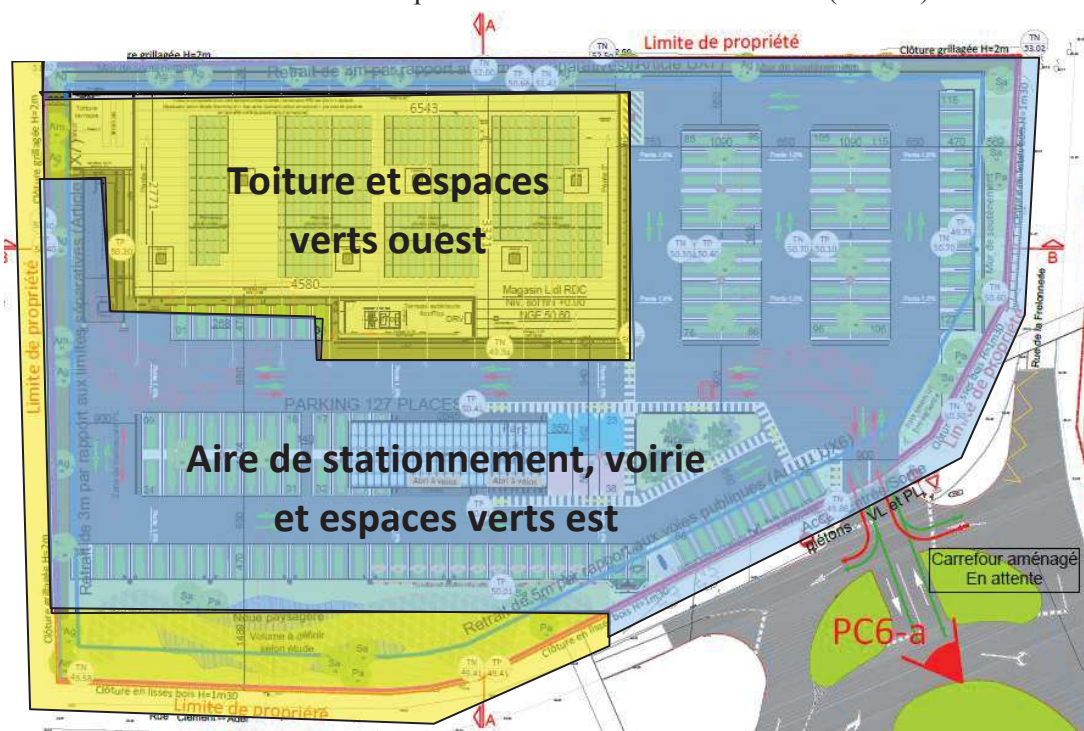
Extrait du plan de masse et division des zones de gestion des eaux pluviales
